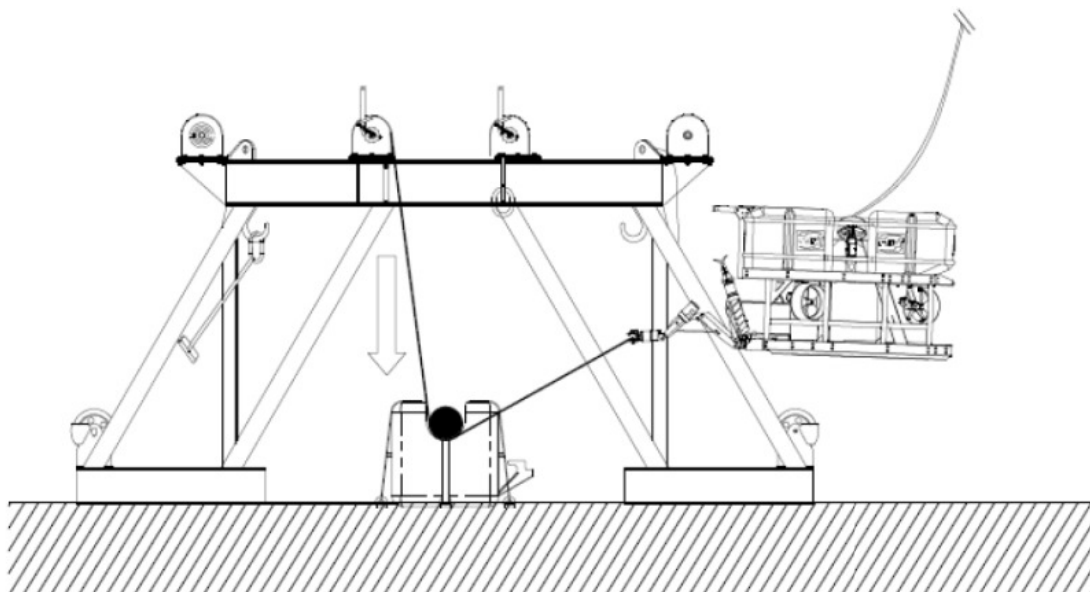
Desconexão do guincho de posicionamento do Grout Bag.
